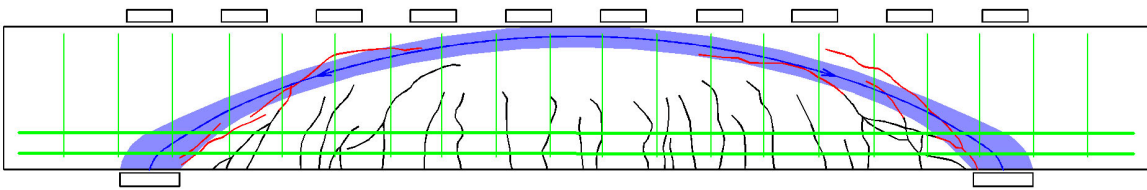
Balken B 1 mit überlagerter Druckparabel und zugehörigen Rissen
